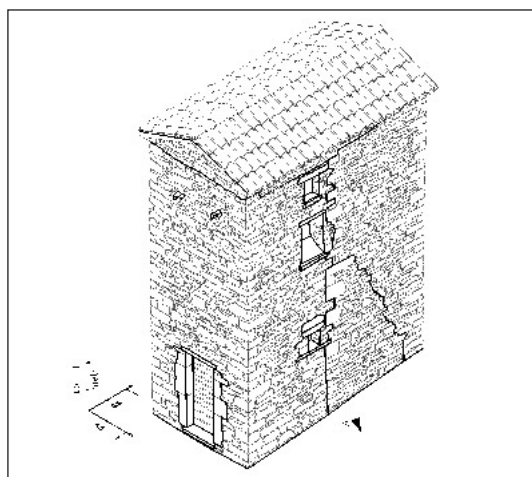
Torre di Monte Erno (Galeata, FC). Restituzione tridimensionale degli elementi strutturali e della stratigrafia muraria (vista assometrica).
